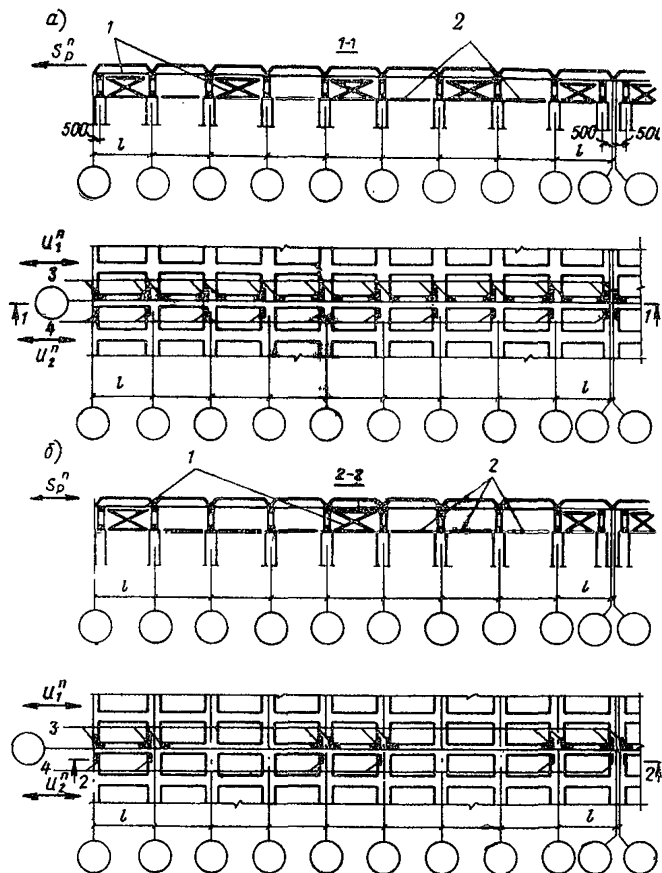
Схемы расположения расчетных сварных швов крепления плит в покрытиях без подстропильных конструкций
